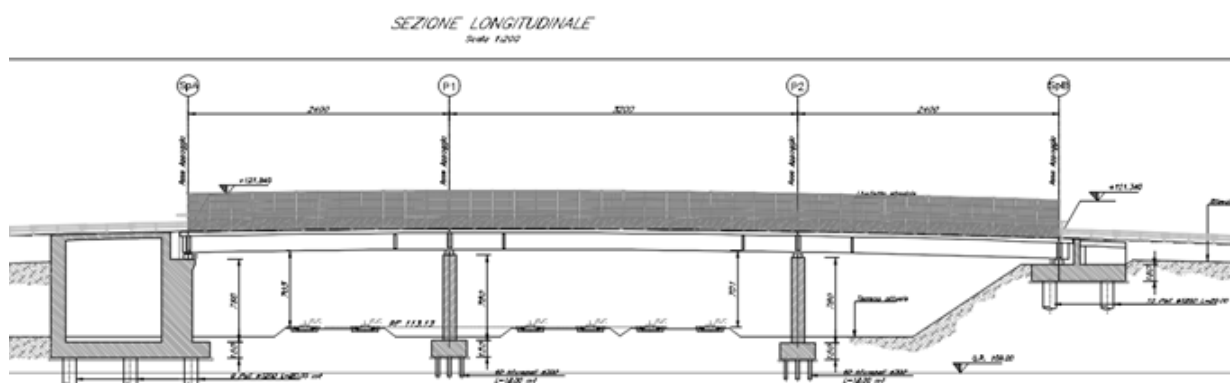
sezione longitudinale nuovo cavalcaferrovia SS10
